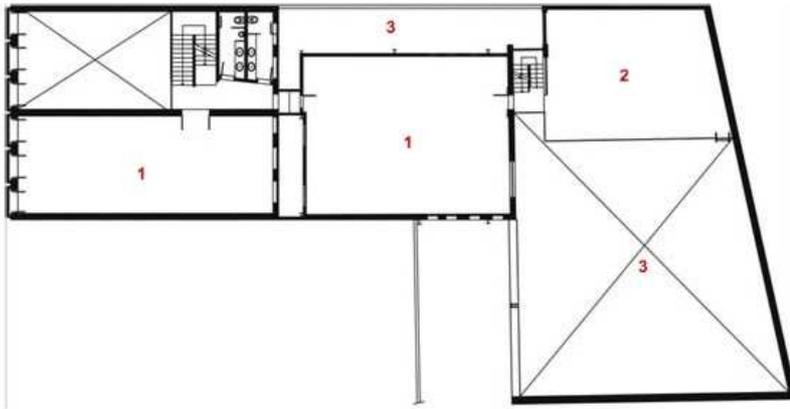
Planta segundo pavimento (Fonte: ARCOWEB)
